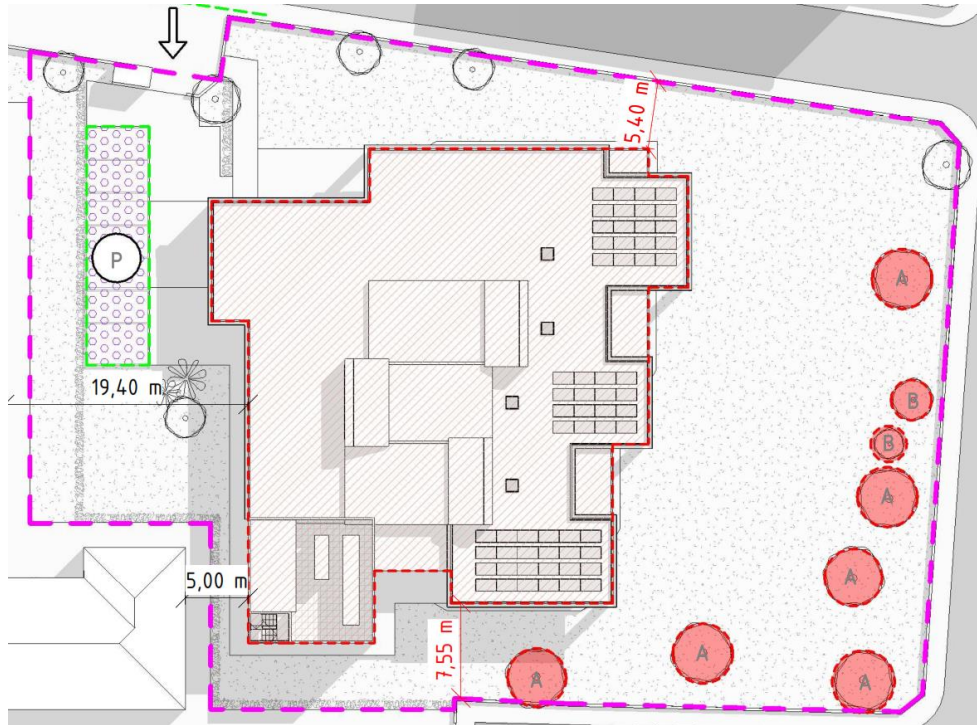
Planivolumetria: stralcio del progetto architettonico
